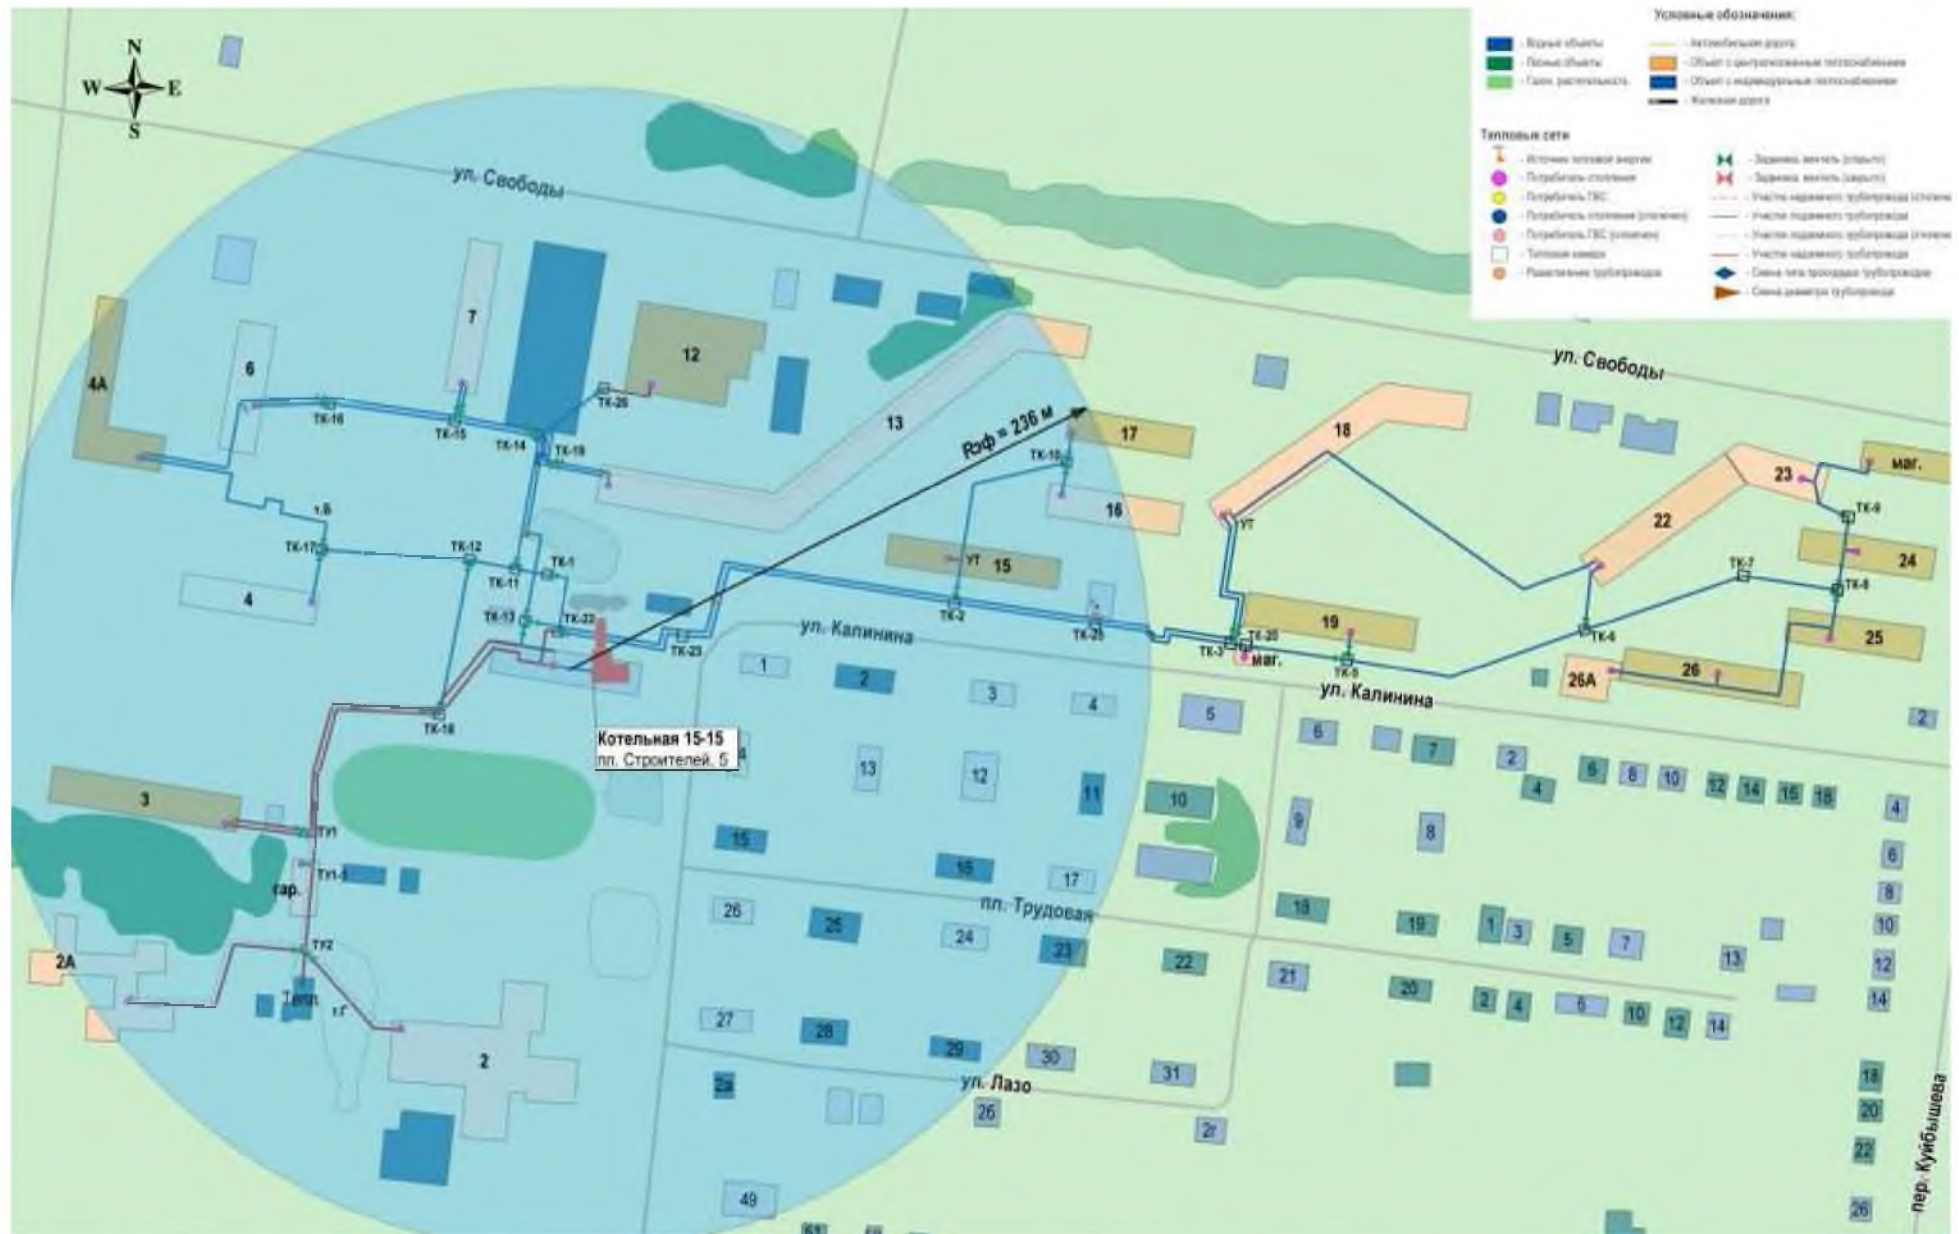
Схема радиуса эффективного теплоснабжения от котельной №15-15, пл. Строителей, 2.
